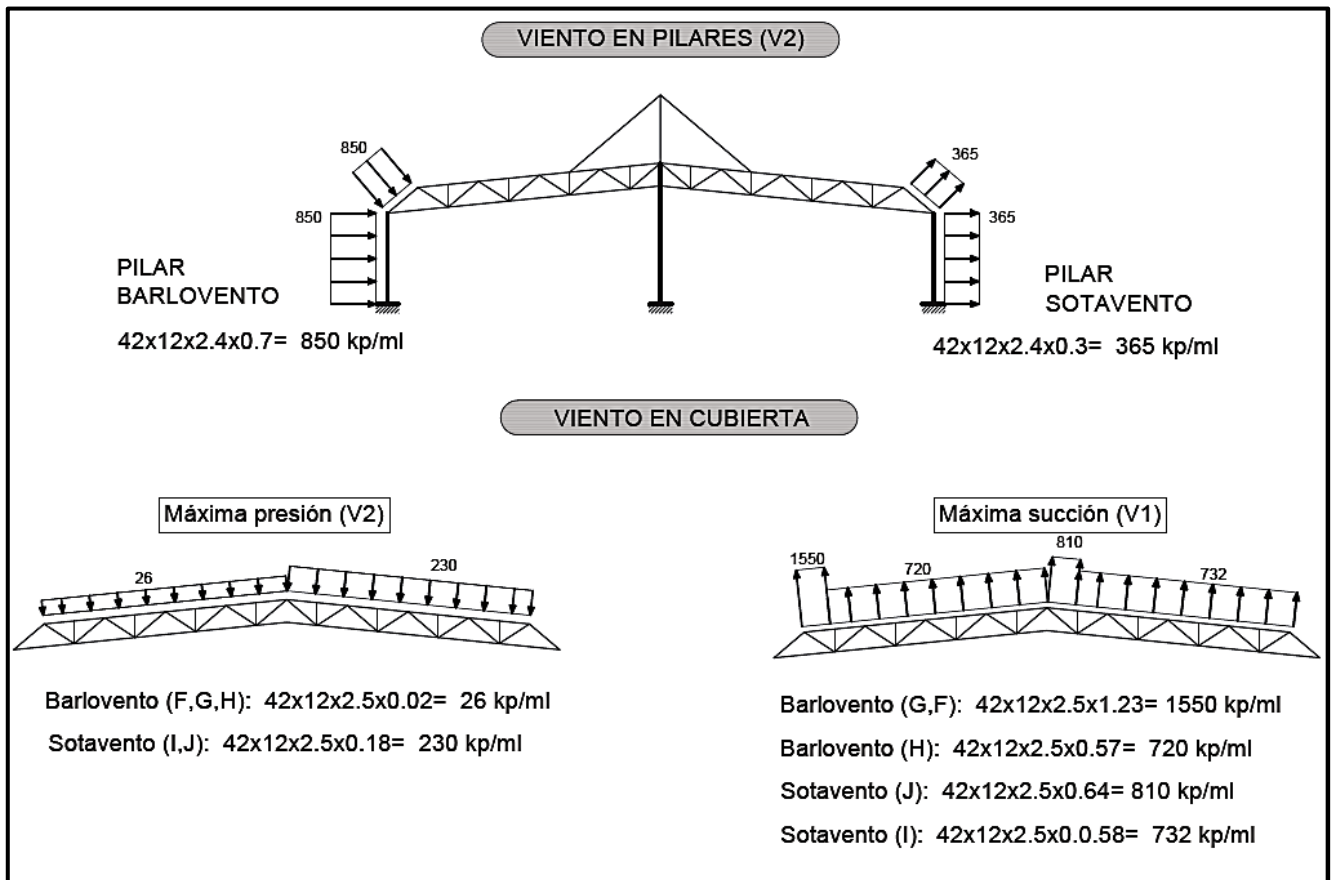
Acciones de viento en pilares y sobre la cubierta.
